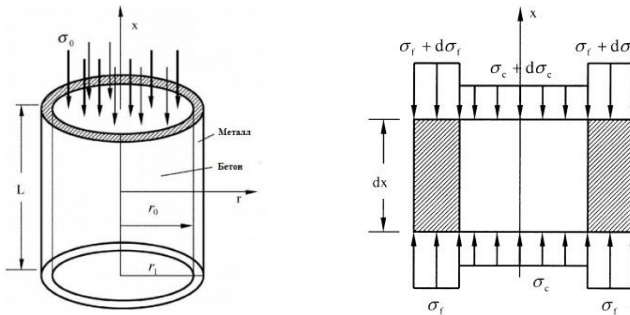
Общий вид трубобетонной колонны под нагрузкой
